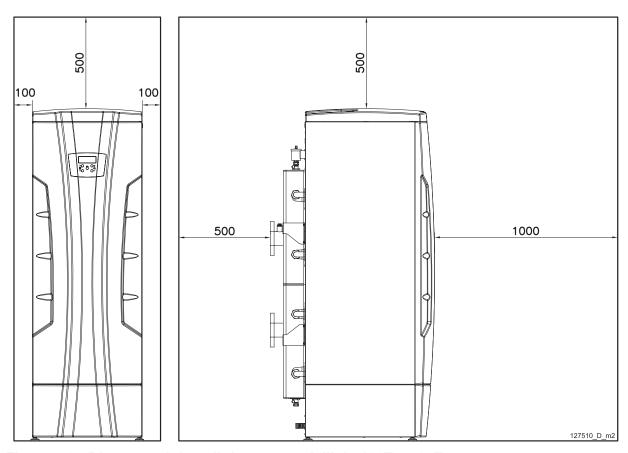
Distanze minime di rispetto modelli da 180T a 280T
